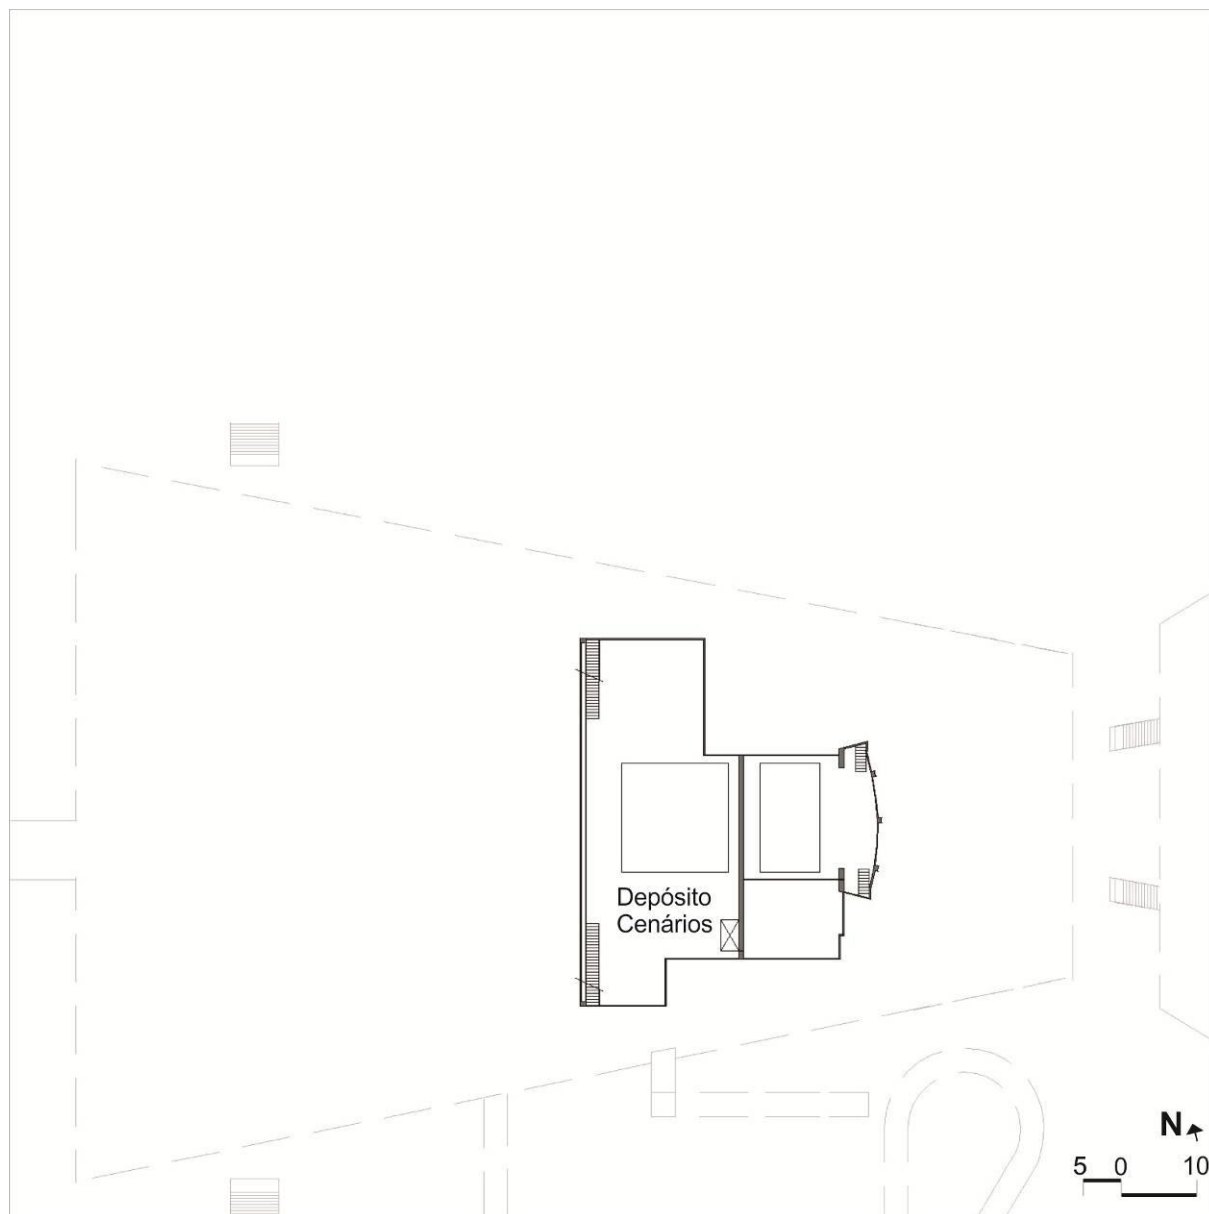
Planta Baixa - Subsolo 5 (-19,00 m).
